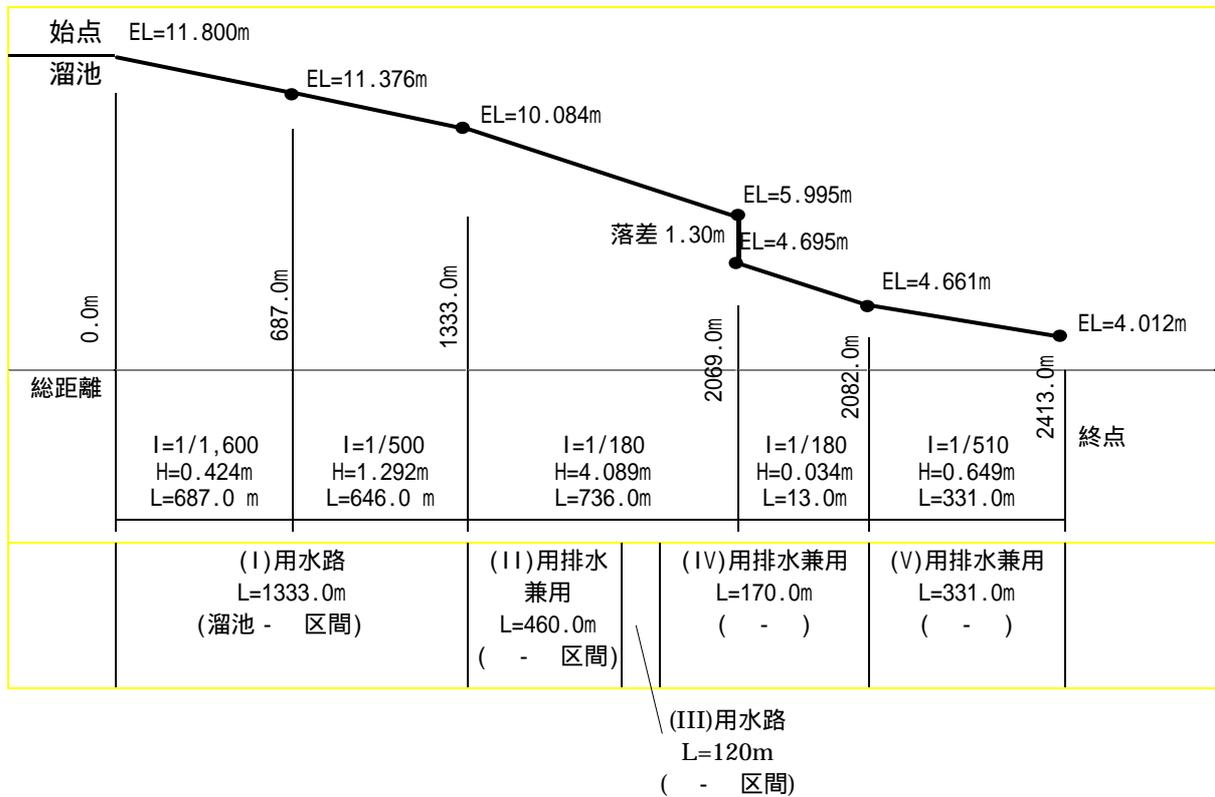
Ho Thanh 水路縦断模式図
